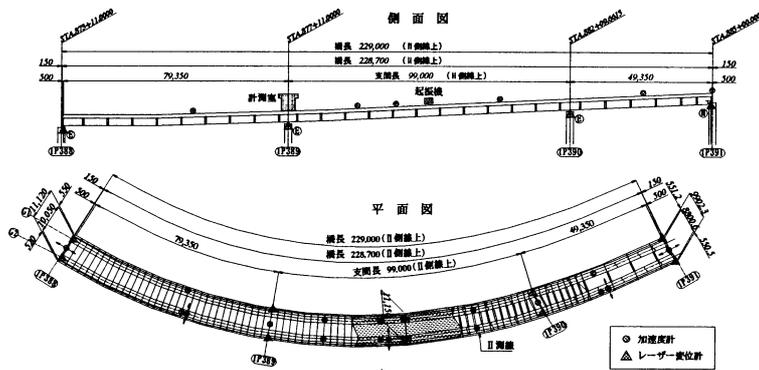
石丸高架橋（Ⅱ測線）の計測器配置図
